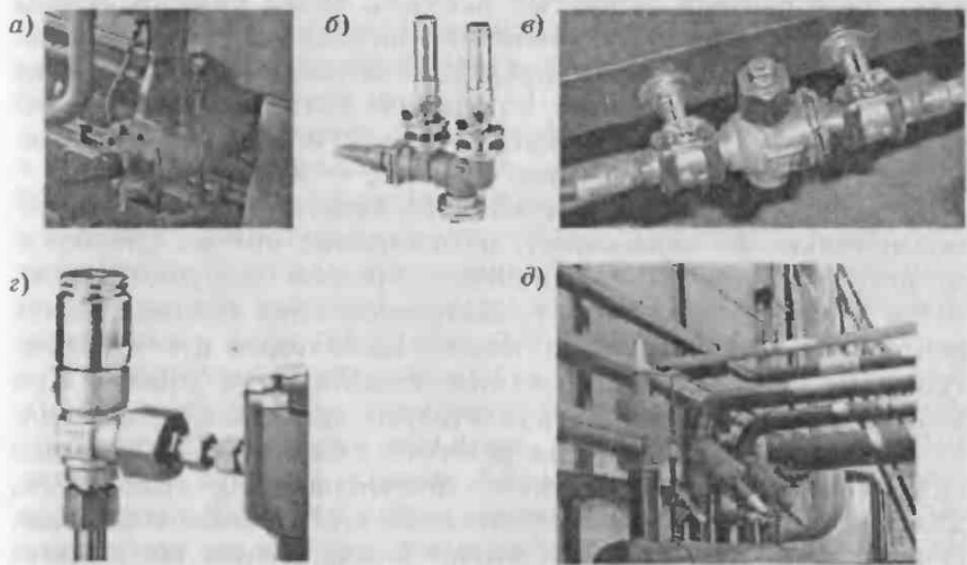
Вентили: *а* — под сварку; *б* — под фланец; *в* — под пайку; *г* — под накидную гайку (штуцерно-ниппельное соединение); *д* — примеры правильной установки вентилей (штоком вверх) и неправильной установки (штоком вниз)
